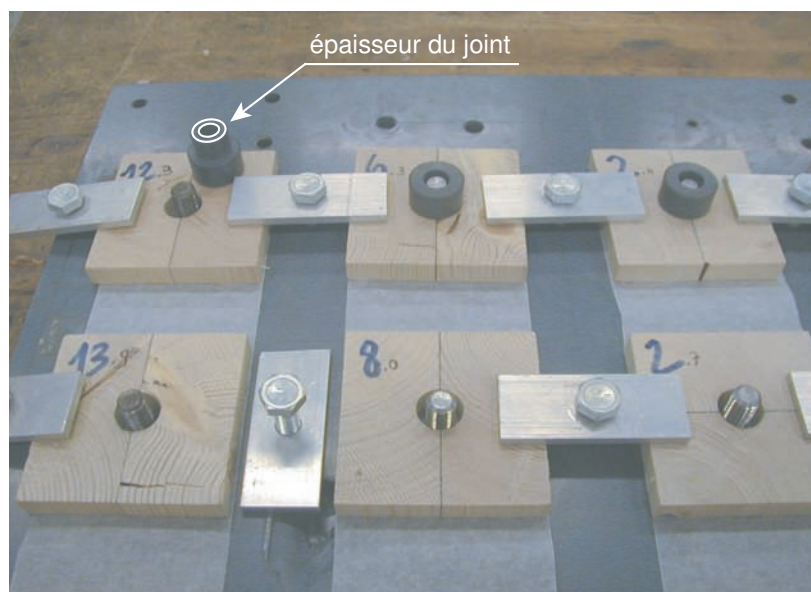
Fabrication des éprouvettes de petites dimensions
